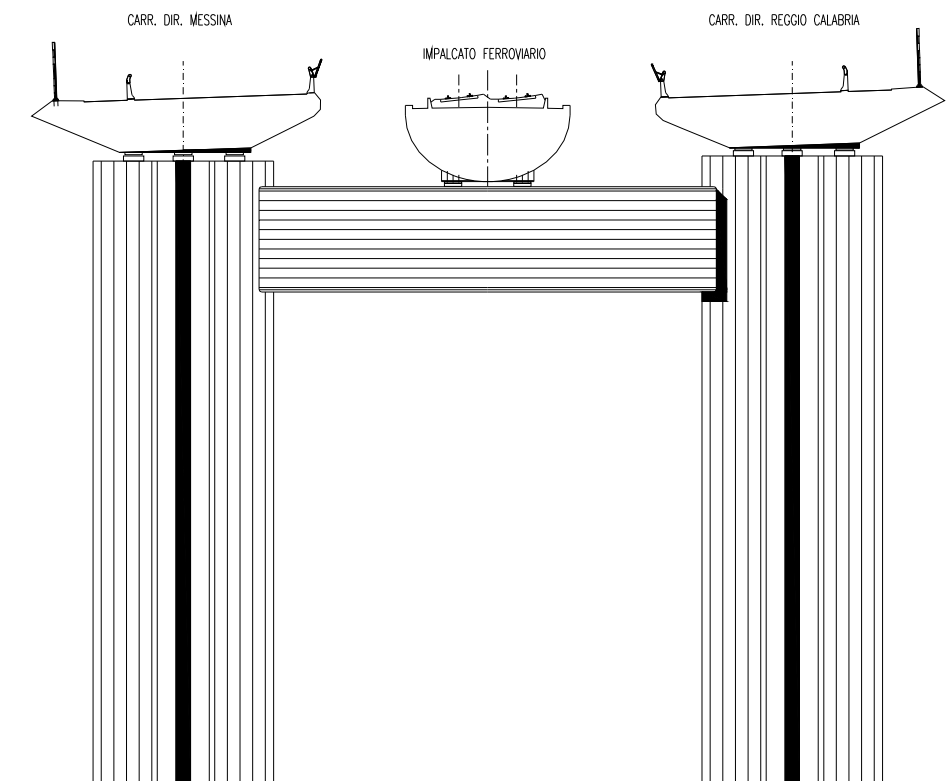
Progetto Preliminare - sezione trasversale dell'impalcato ferroviario e stradale in corrispondenza della pila
